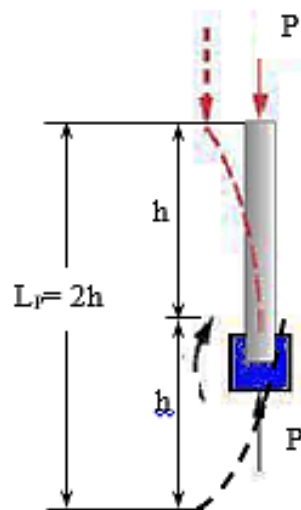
Condición de las columnas de la estantería. Fija – libre, bajo la acción de una carga que pasa por el centro de su sección transversal.
